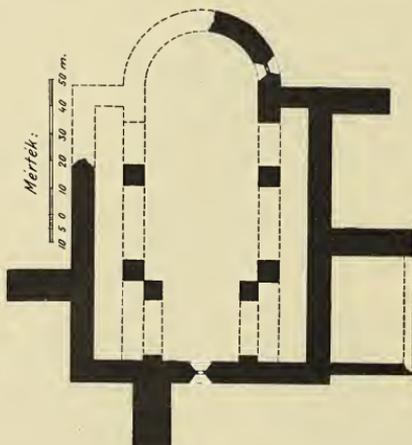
Grundriss der Kirche zu Ecsér.
